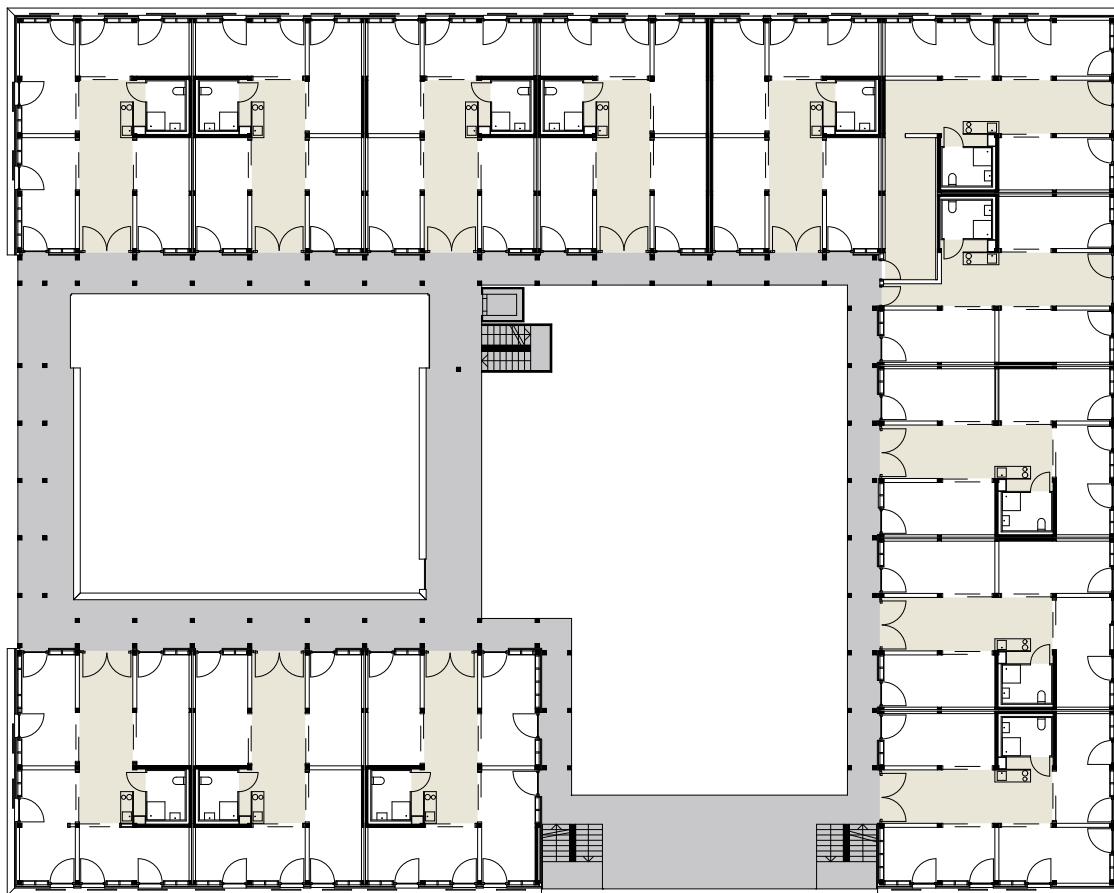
Grundriss Regelgeschoss, M. 1:375 [© BF Vario]
